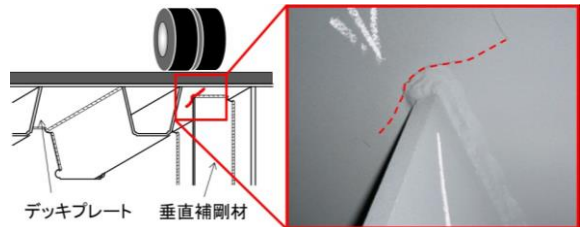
デッキプレートと垂直補剛材の溶接部から発生した疲労き裂
